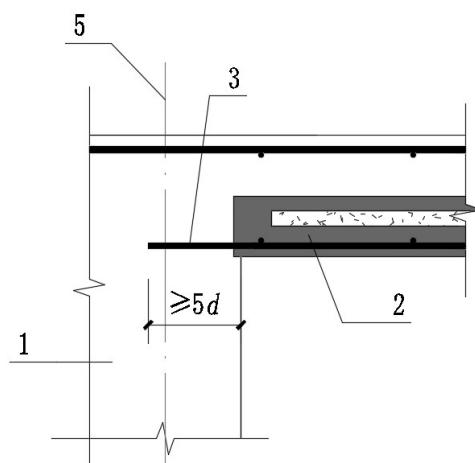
夹芯叠合楼板板端支座处构造示意一
